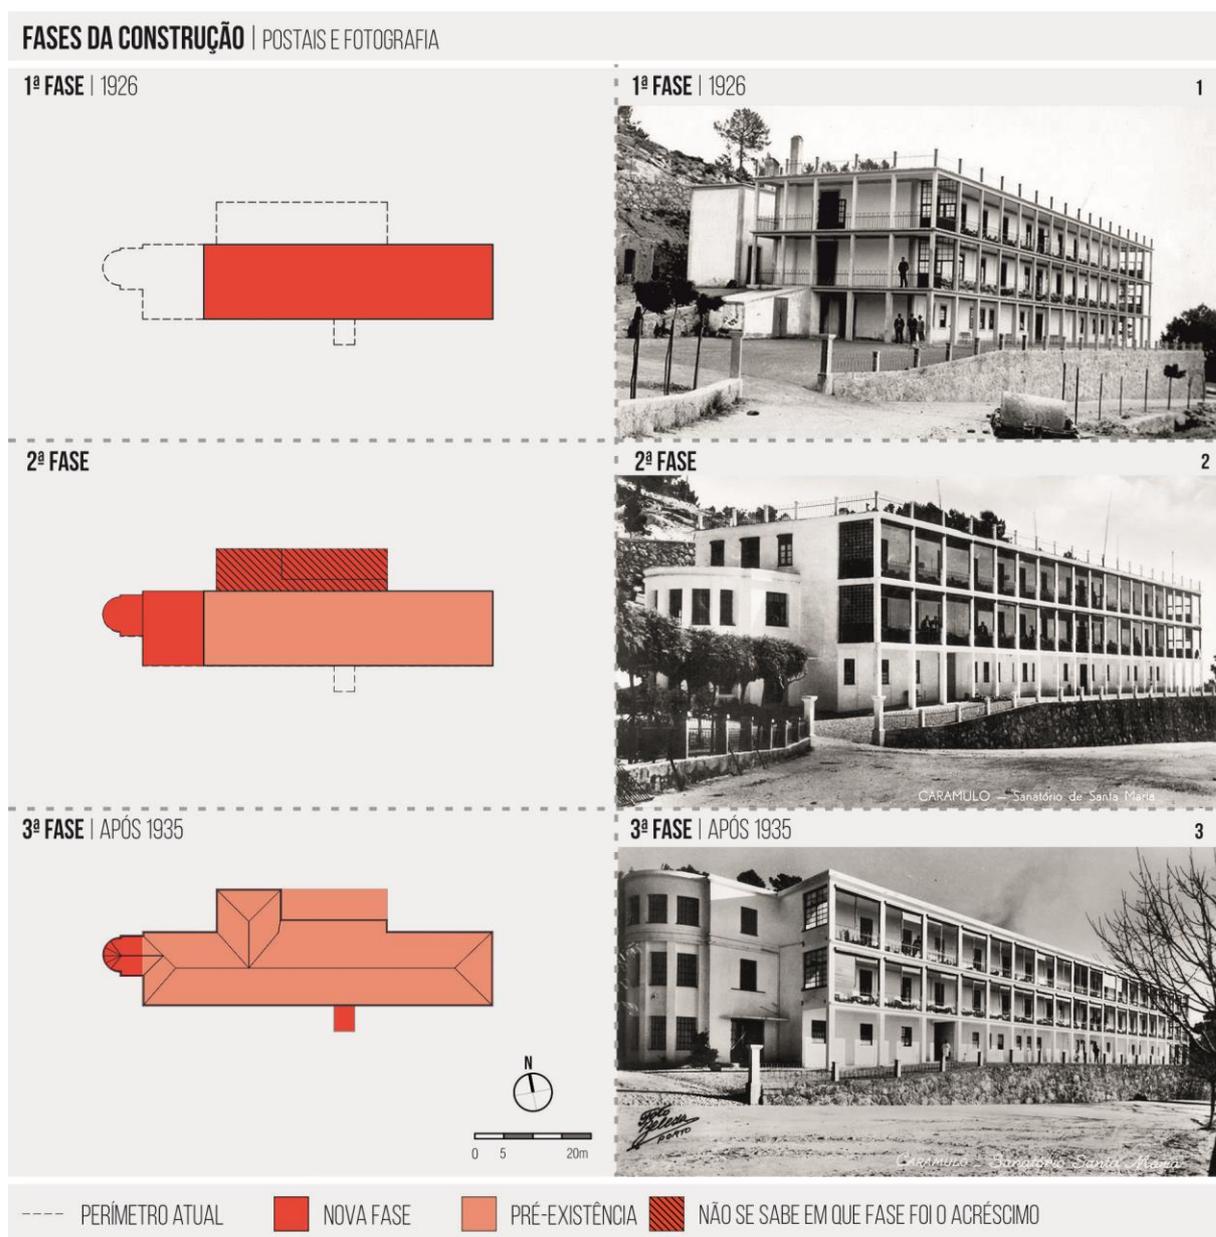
Fases da construção com alteração do perímetro e volume (1,2 e 3 – postais da Biblioteca Tomaz Ribeiro, Tondela)
